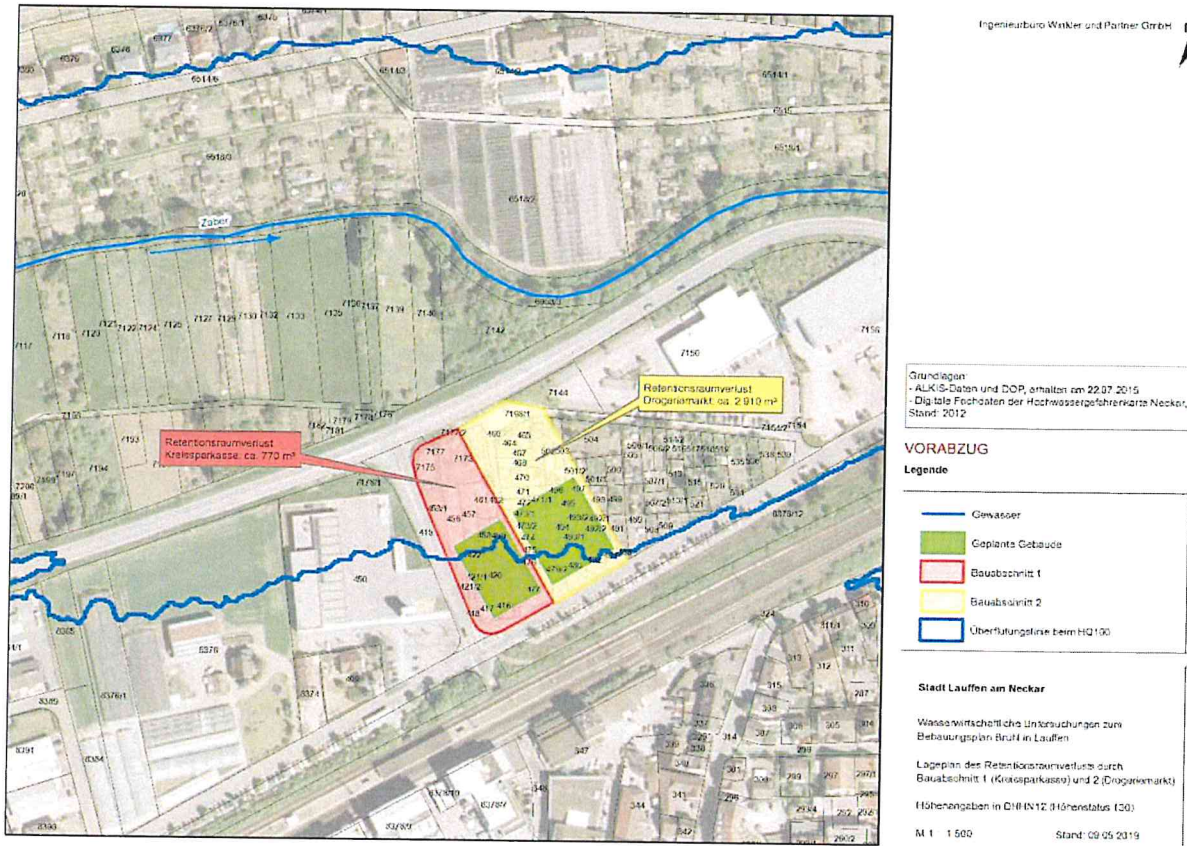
Lageplan Retentionsraumverlust durch Bauabschnitt 1 und 2 (ohne Maßstab)
